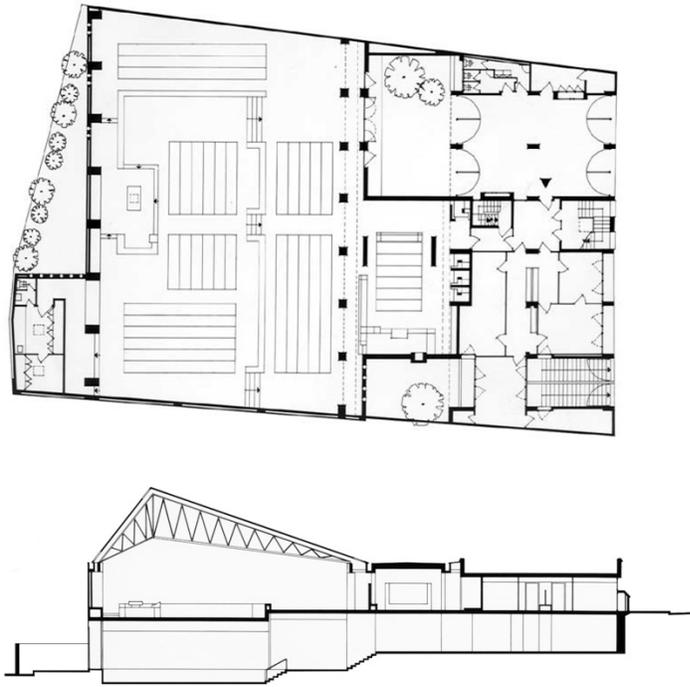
Planta y sección de la iglesia parroquial de *Sant Sebastià*, obra de MBM. Archivo del autor
